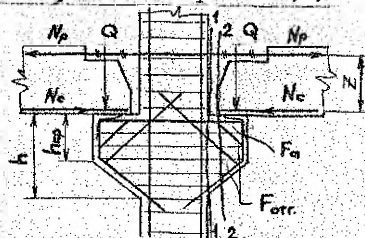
Схема передачи усилия от ригеля перекрытия на консоль колонны
